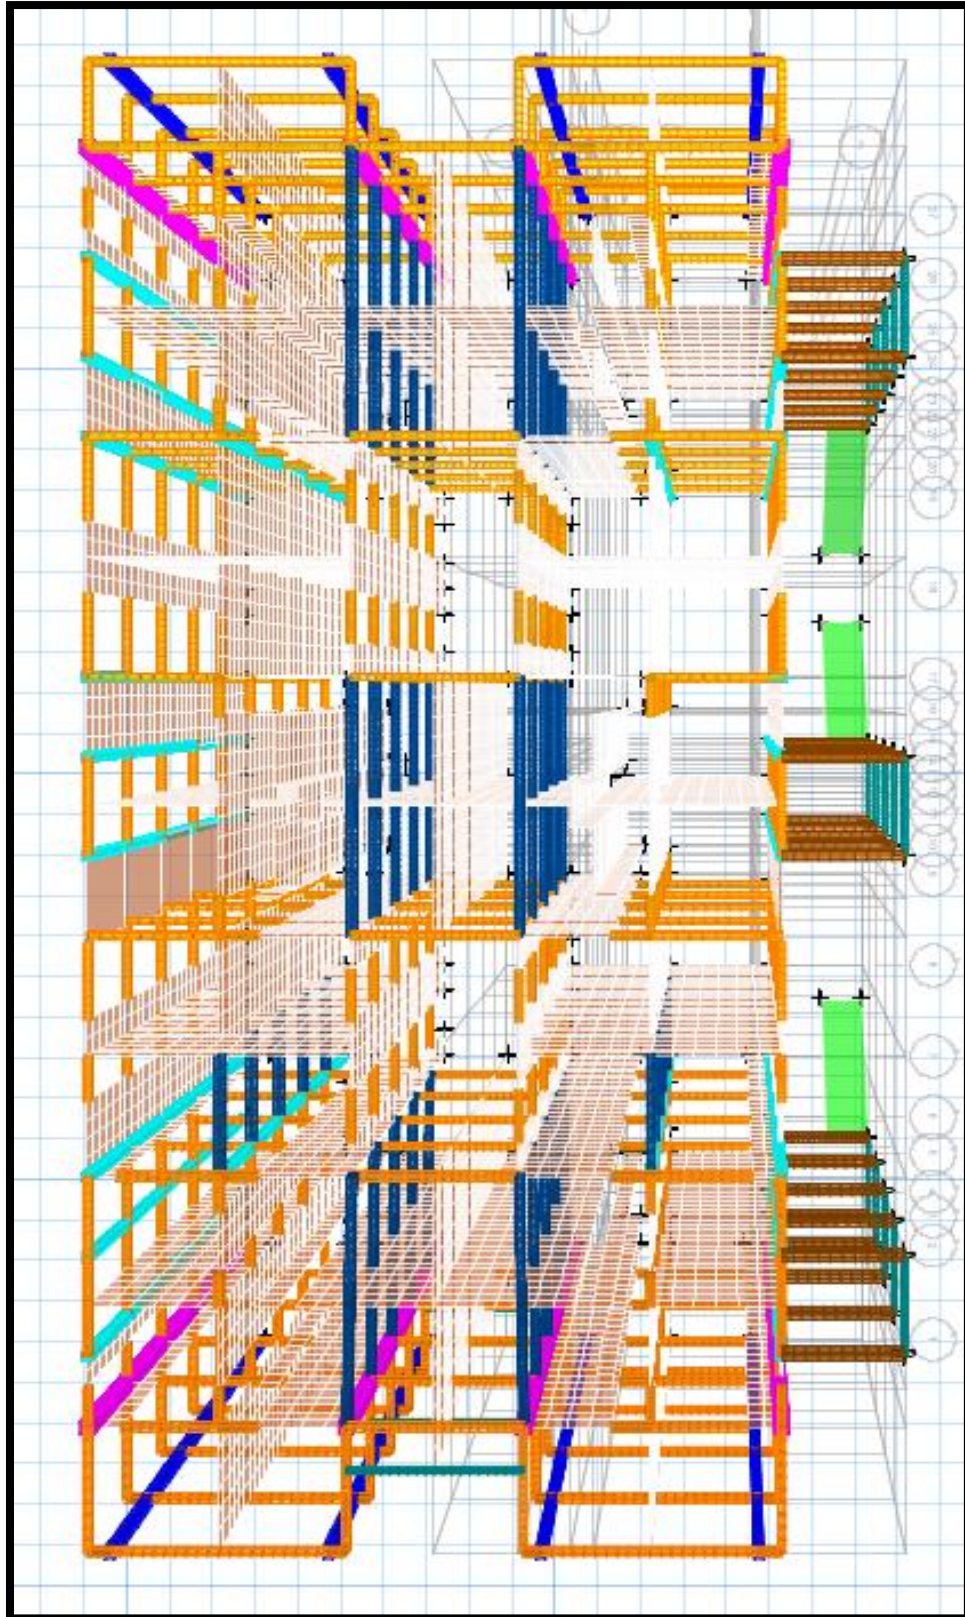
Vista de Vigas y Muros de Modulo 02 (Muros de Albañilería Confinada)
